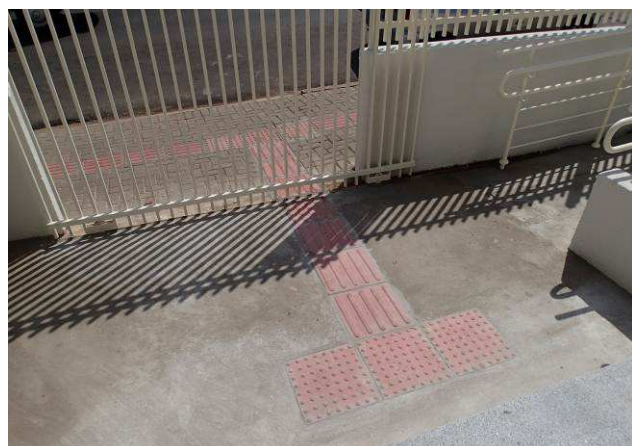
C: Placas cimentícias de piso podotátil instaladas no passeio e área externa.
